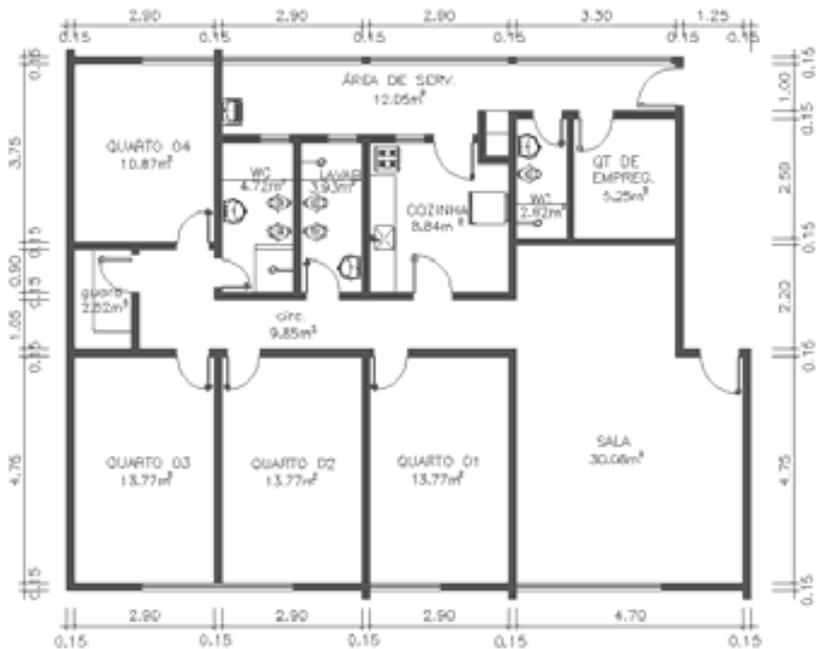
SQS 307 – Bloco H – Planta Original
